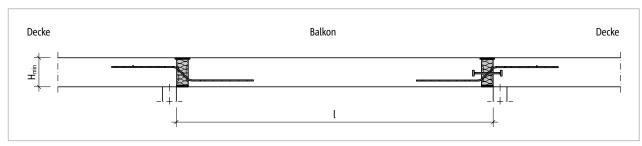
Schöck Isokorb® T Typ QP-Z, QP: Statisches System
